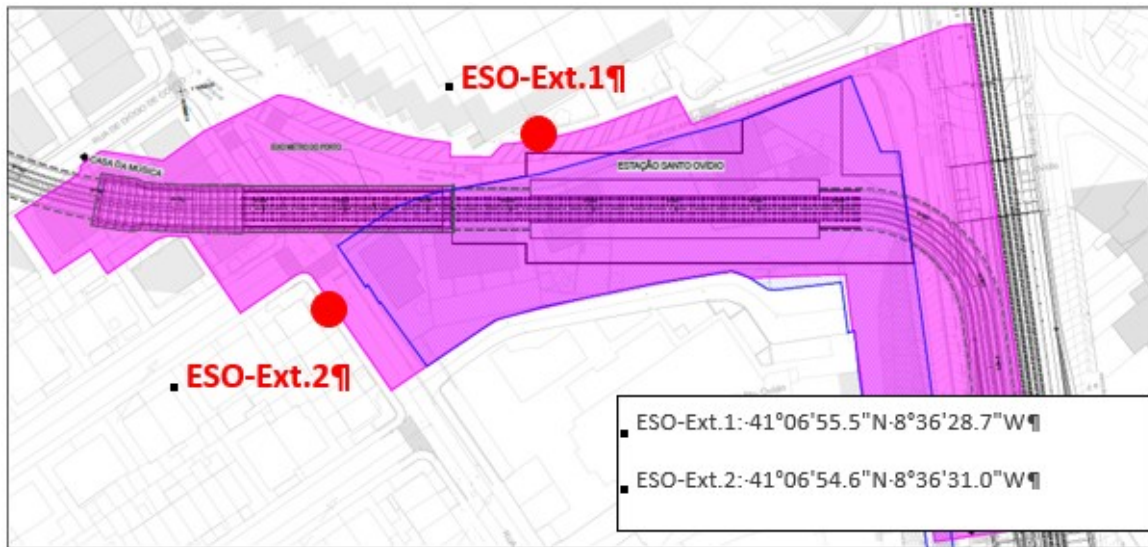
Pontos de monitorização junto Estação de Santo Ovídeo (vibrações – construção)
